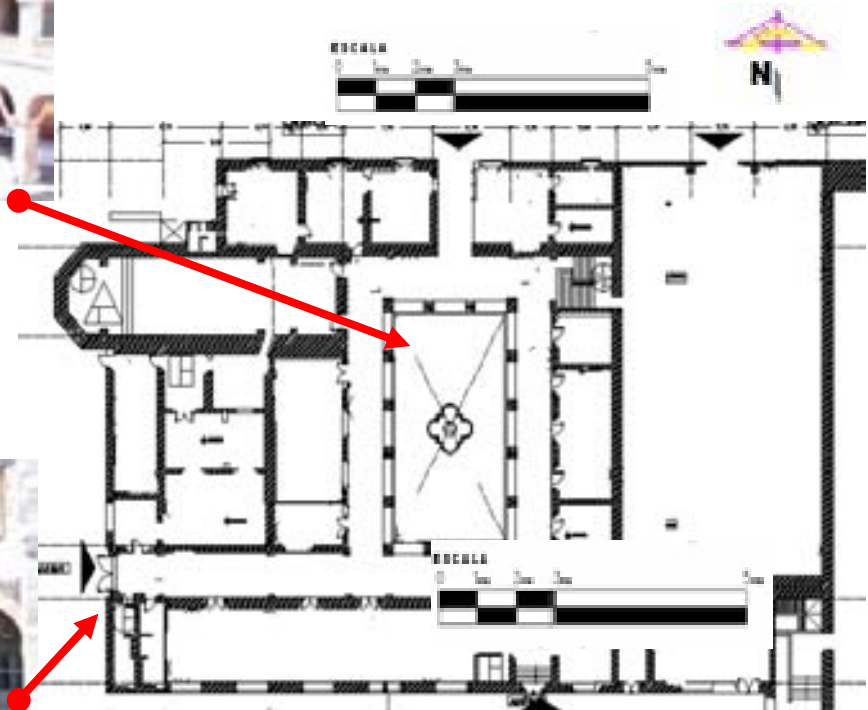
PLANTA ARQUITECTONICA CASA DEL HACENDADO ESTADO ACTUAL.
